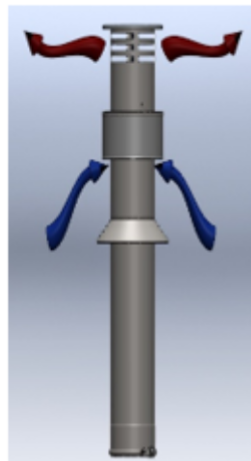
Terminal vertical fixe PLA (conduit PLA)
